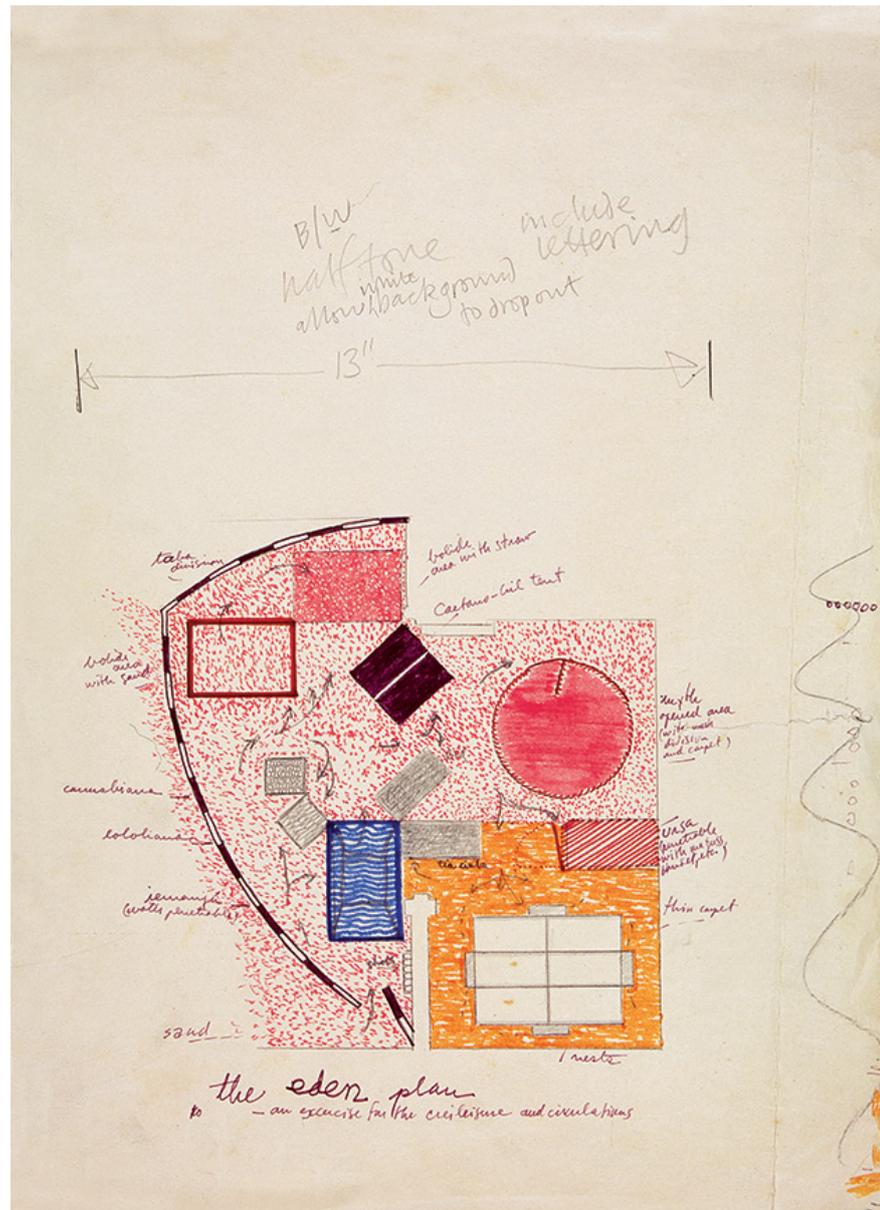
Planta do Éden – Whitechapel Experience, 1969.
